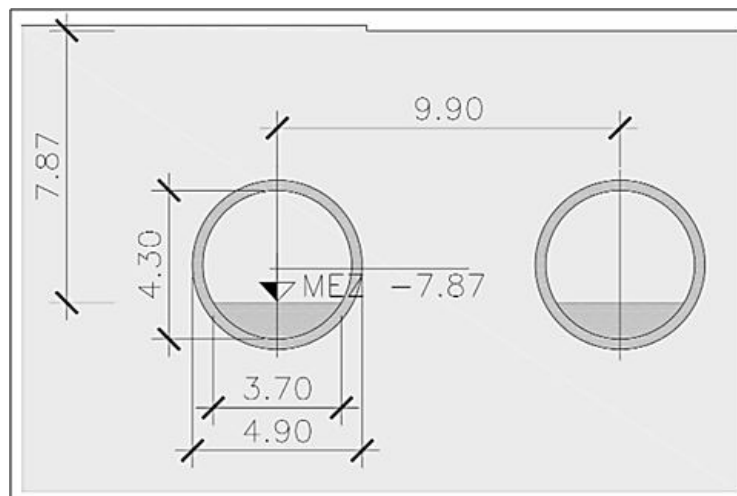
Galerías de conexión de accesos satelitales a estaciones mediante túneles independientes construidos con sistema Liner
